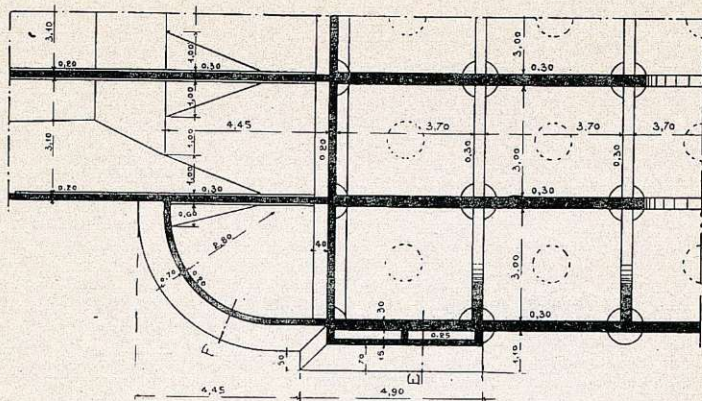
Planta de un semiestribo del puente Pasteur (Lyon).
